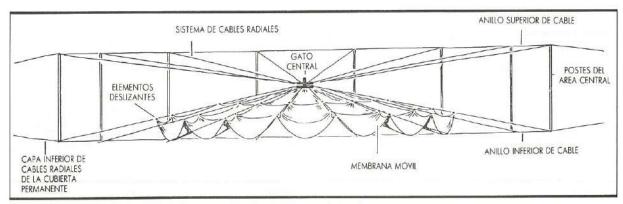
Plaza de toros de Zaragaza durante su operación de eliminación de la cubierta.
